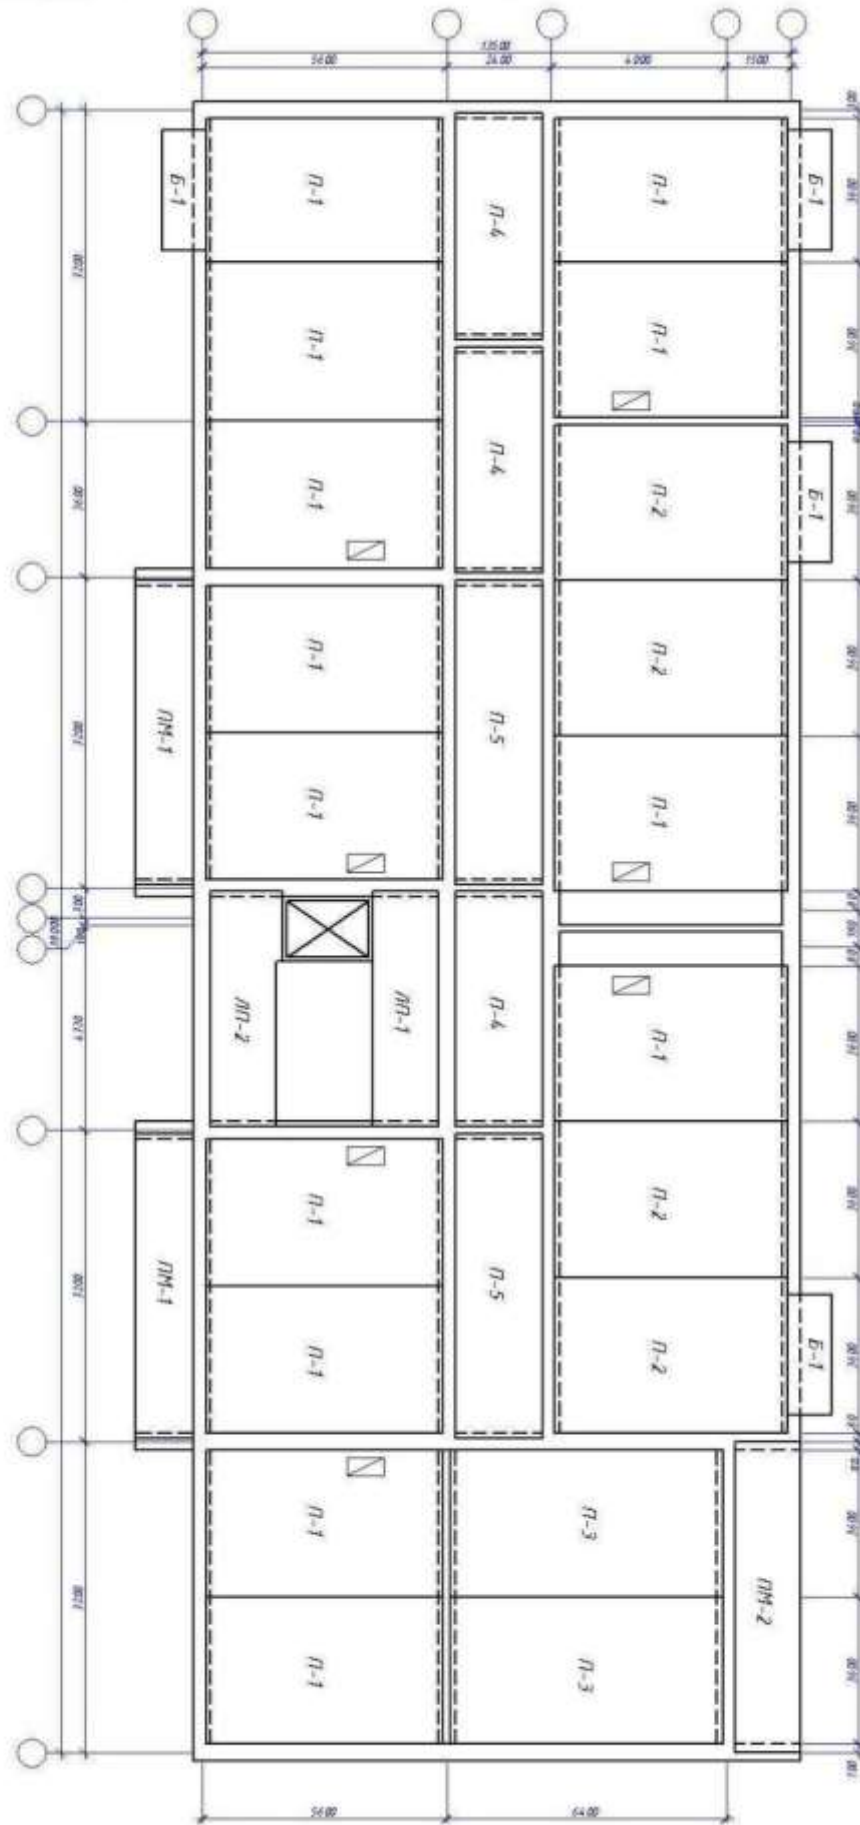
План перекриття з плитами, що обпіраються по контуру
